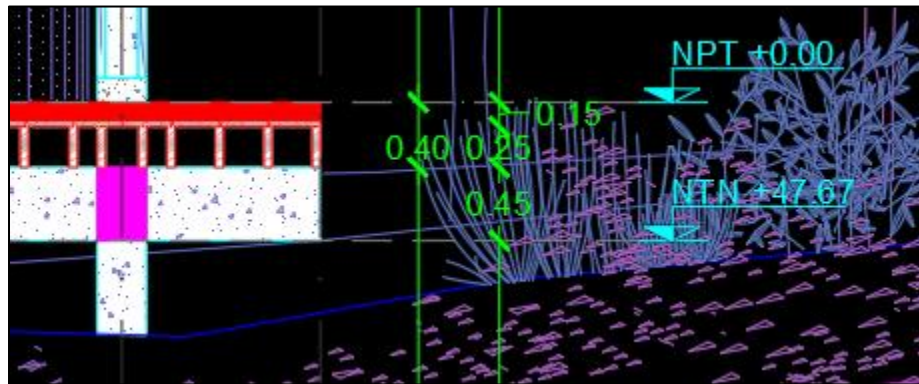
ESPESORES DE ENTREPISO DE PLANTA SÓTANO A PLANTA BAJA
